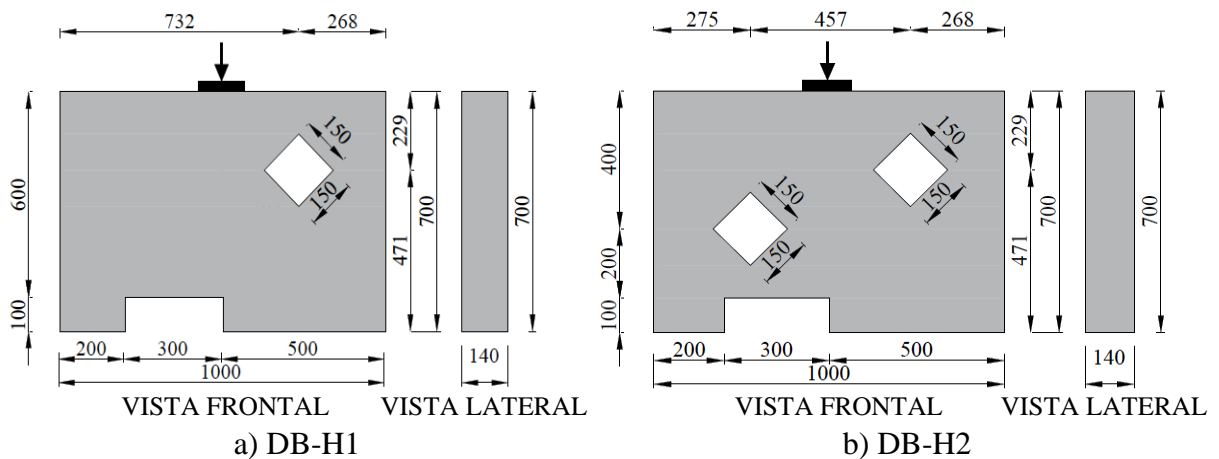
Geometrias das vigas-parede (dimensões em mm)
